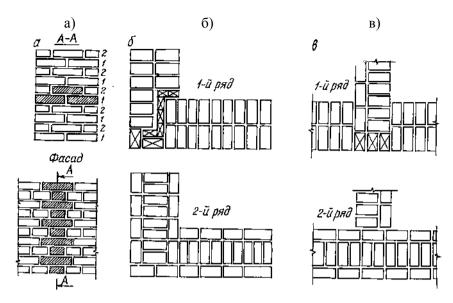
Однорядная система перевязки швов: а – фасад; б – кладка прямых углов и вертикальных ограничений; в – кладка примыканий стен
